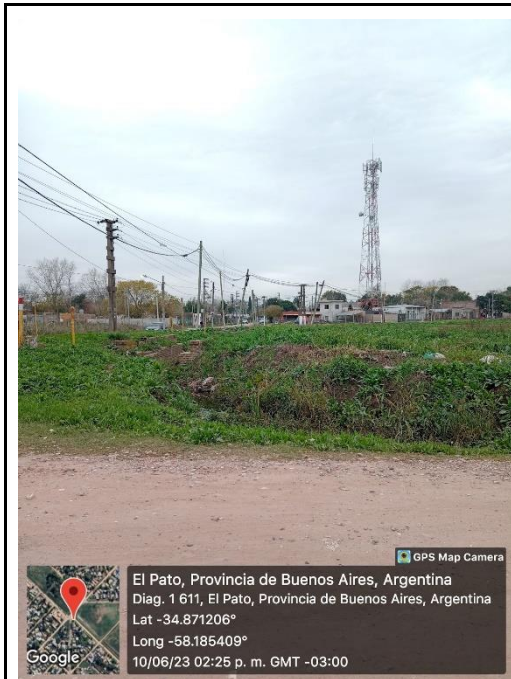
Predio donde va a ser instalada la planta sobre calle 611
